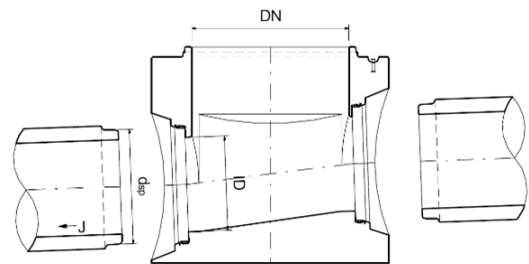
Anschluss mit CENTUB® Röser Stahlbetonrohre mit Gefälle J ≤150 ‰
